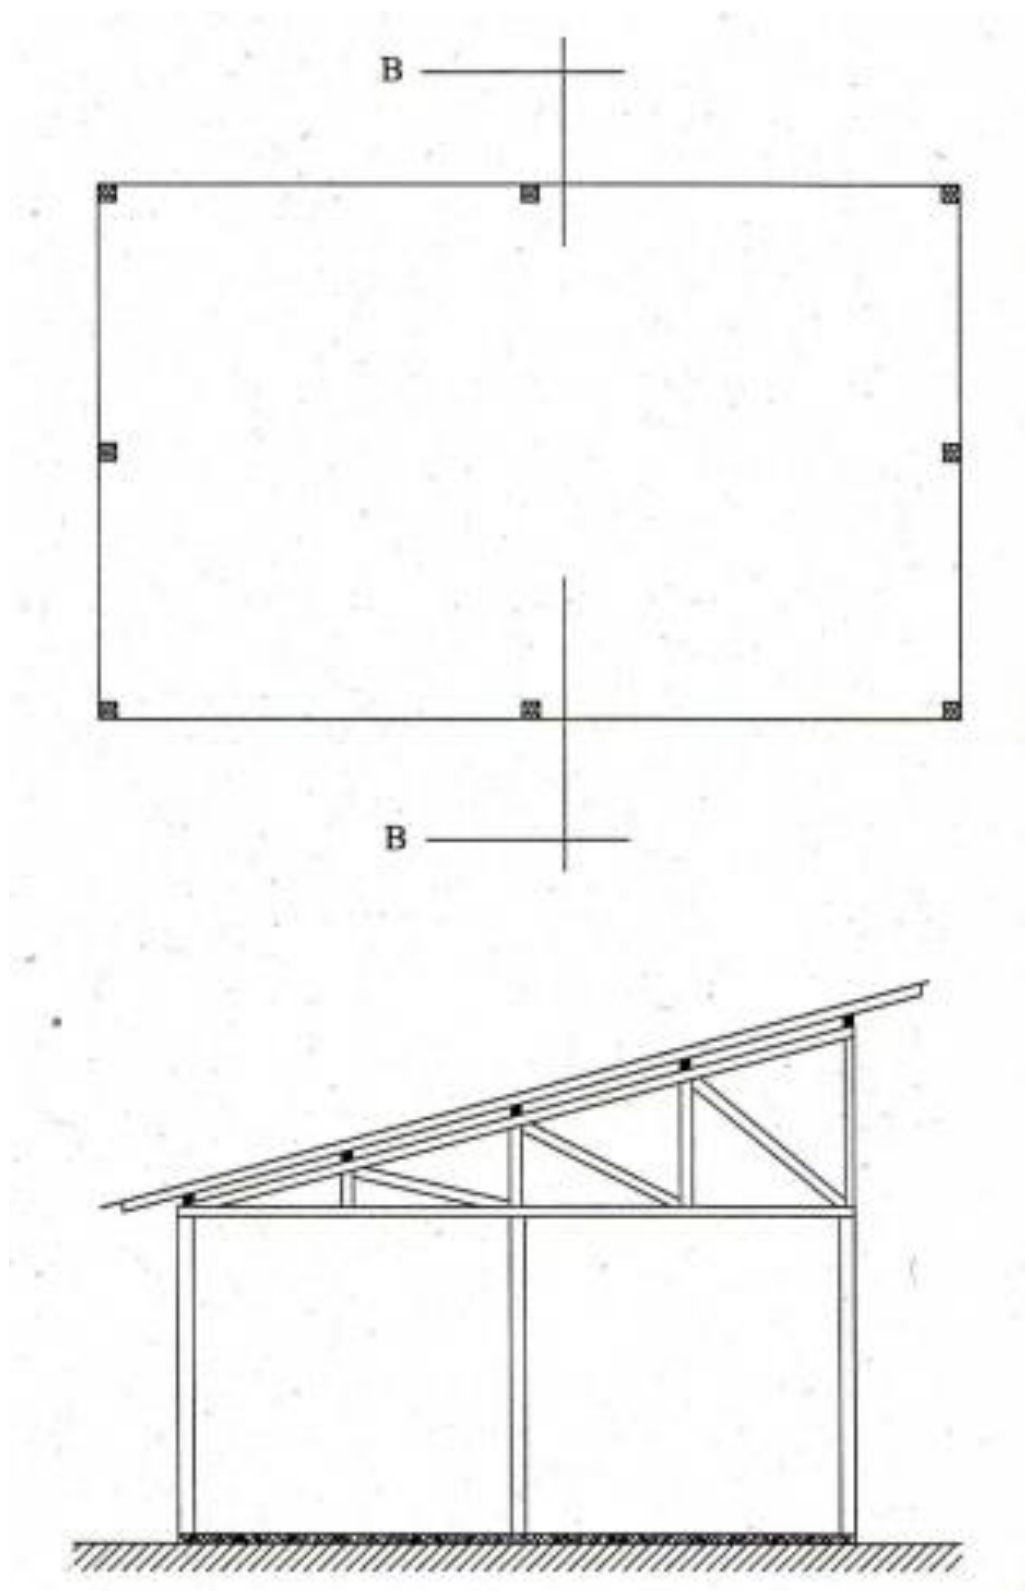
Planta Baixa e Corte da Sede Administrativa.
